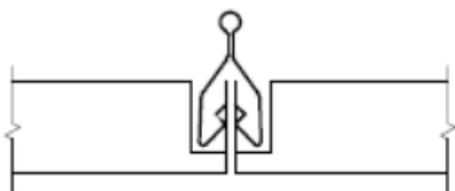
Klemmsystem mit verdecktem Klemmprofil
